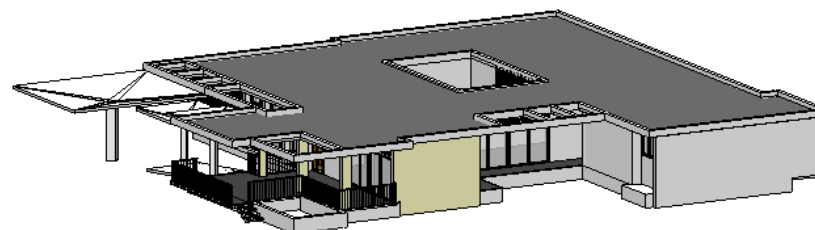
Vista Tridimensional. Fuente: elaboración propia
